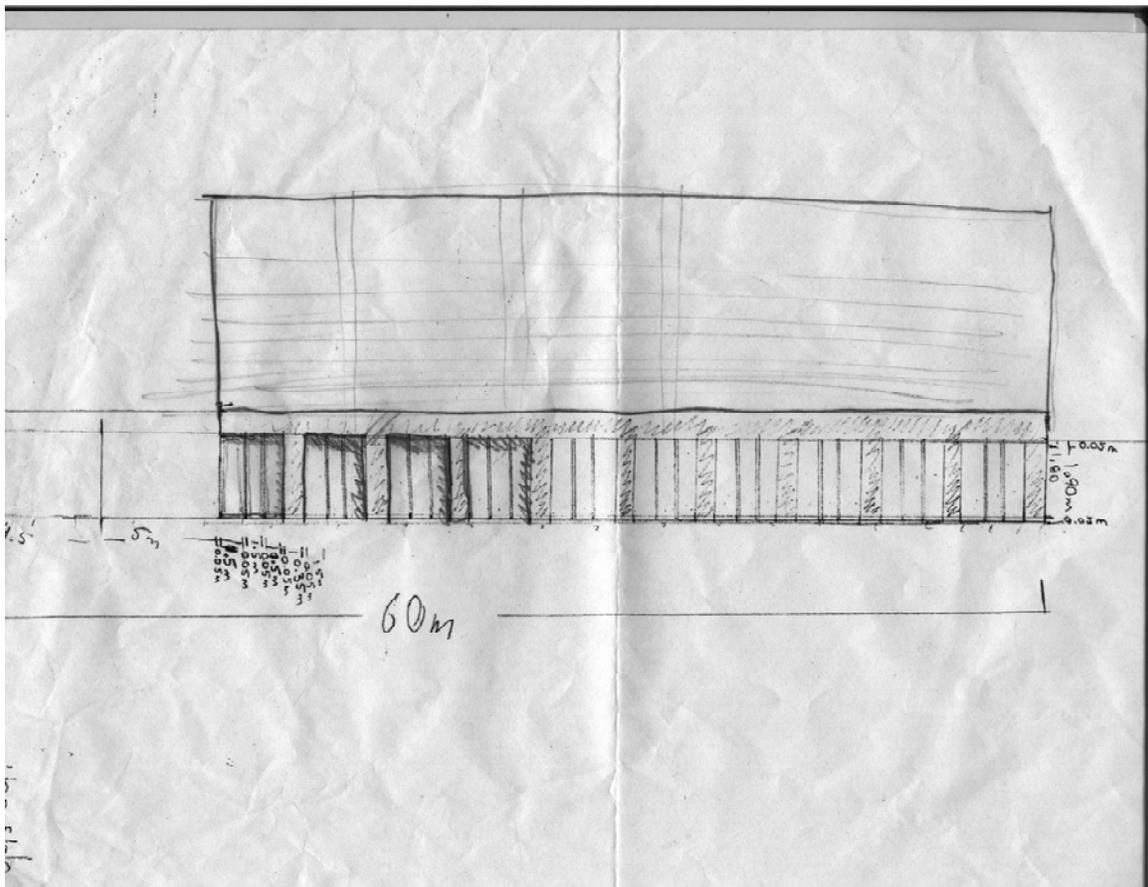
Fachada principal de acceso a la alberca del Plan Sexenal
